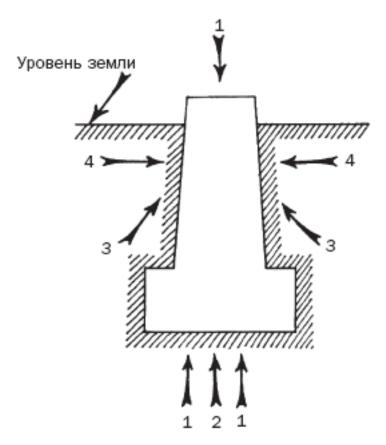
Силы, воздействующие на фундамент: 1 – сила подземных вод; 2 – сила пучения промерзающего грунта; 3, 4 – силы, действующие по касательной на боковые поверхности фундамента
